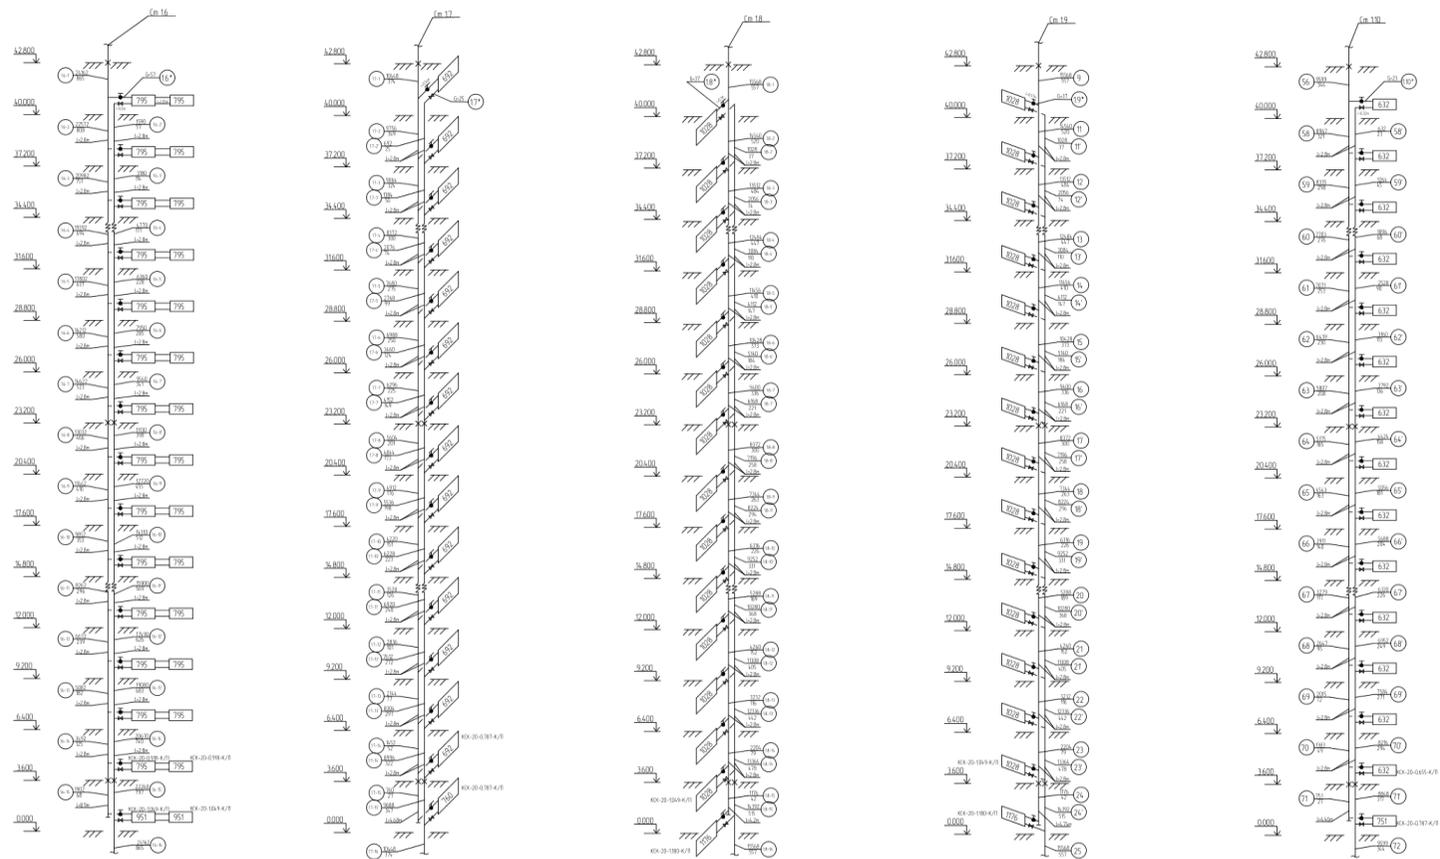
Расчетная схемы стоек 1.6-1.10
